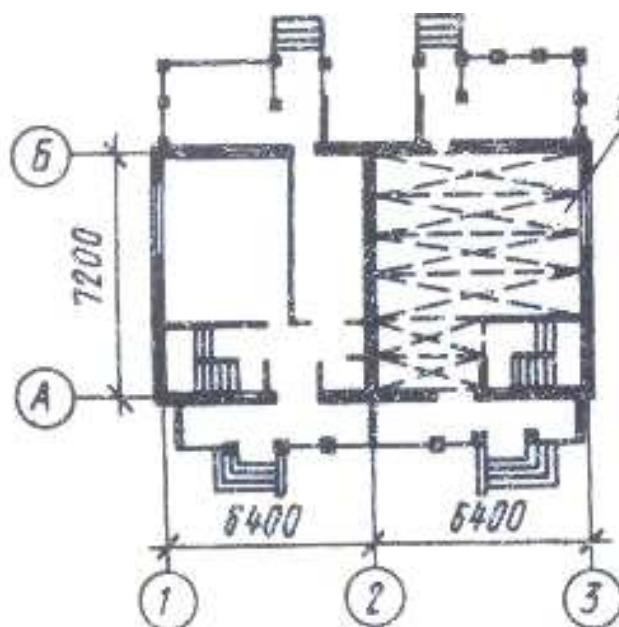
Схема с большим шагом поперечных несущих стен (1 – панели перекрытий)
